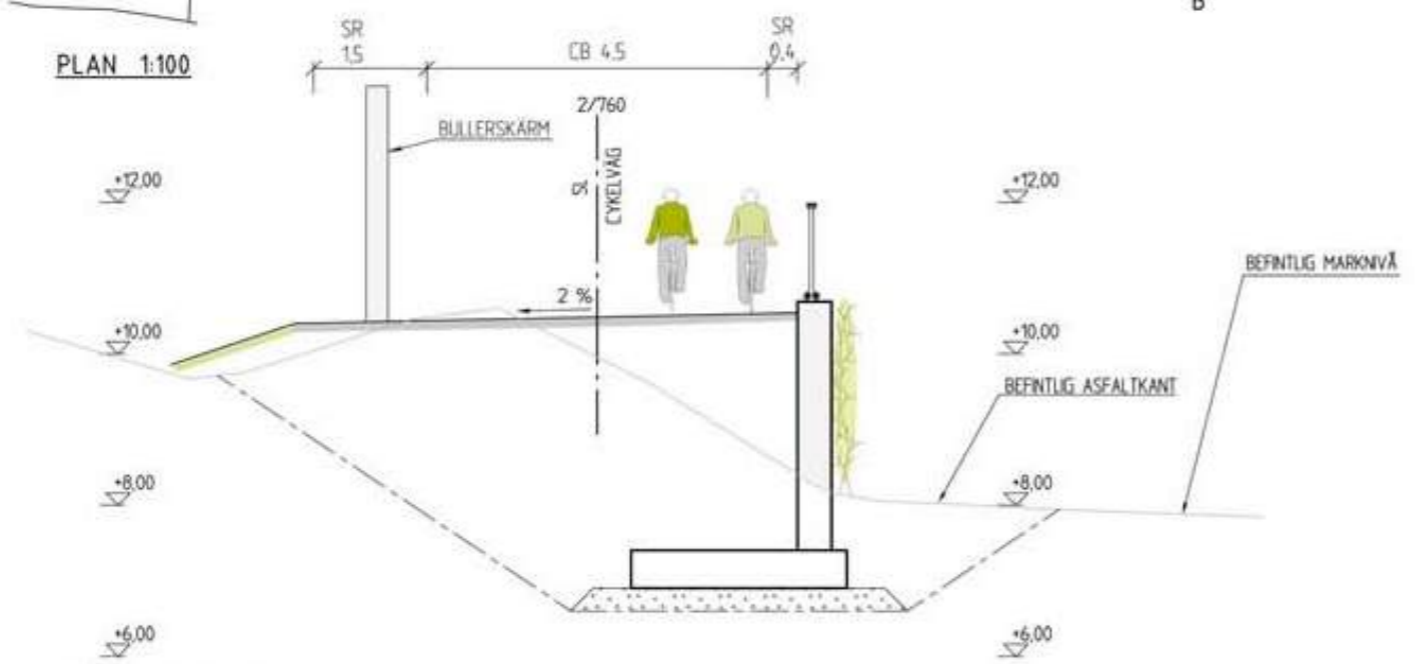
, 92, 93. Elevation, plan och sektion för stödmur i betong som förslagsvis kan kläs med vajrar eller spaljéer för klättrväxter vid Annelund. Ett svart cykelräcke föreslås. För mer information om bullerskärmen se sida 78-79.
